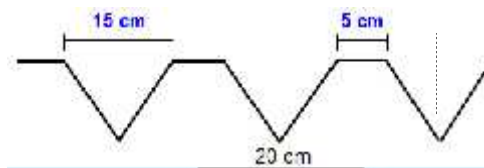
Esquema de configuración de vertedero perimetral para los Sed. Secundarios
